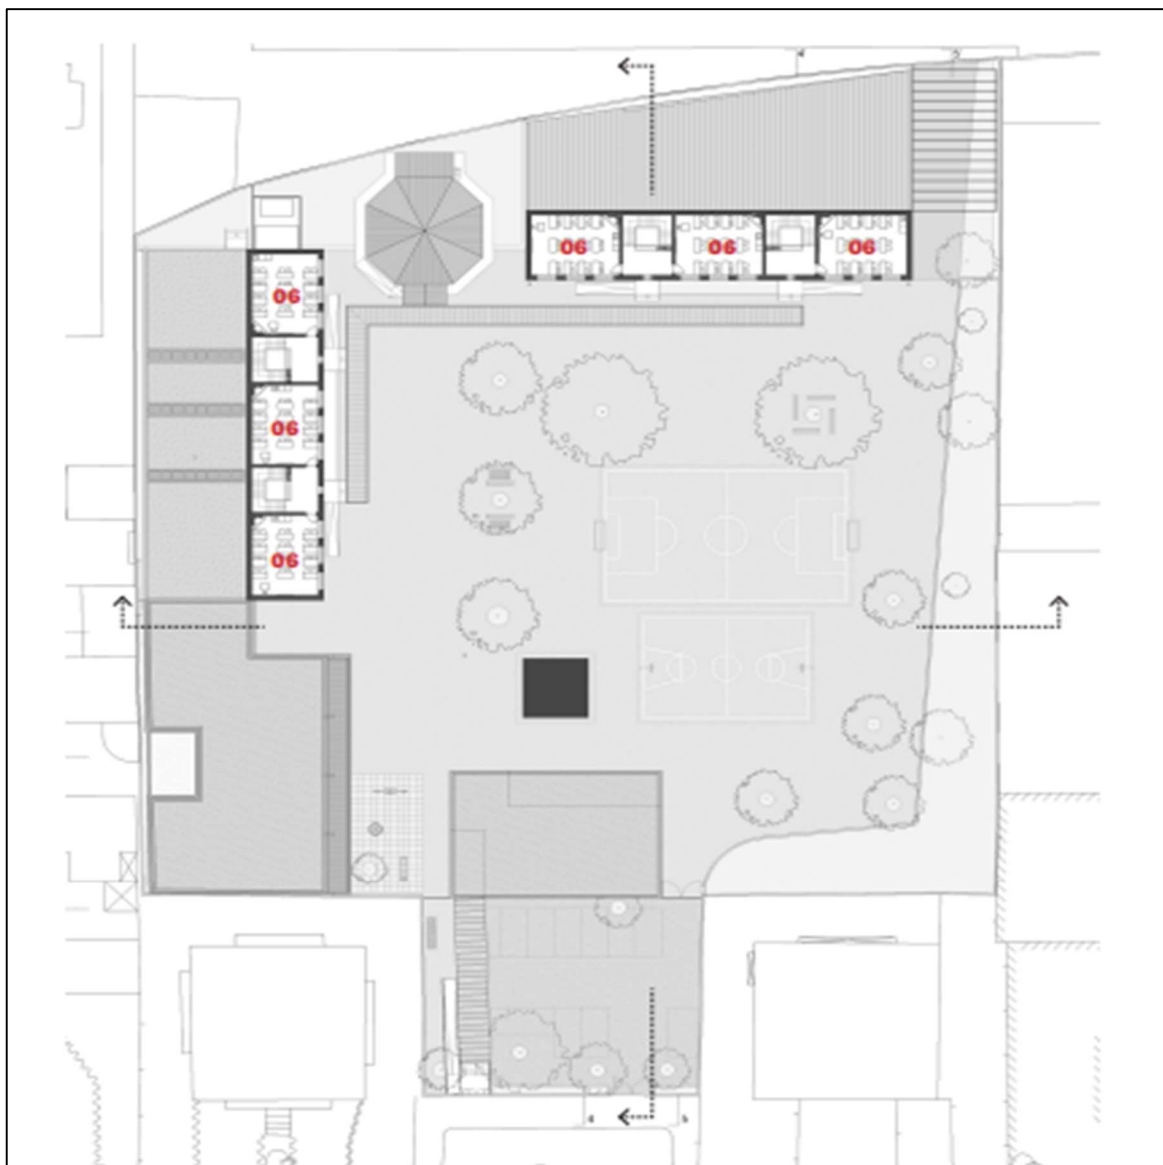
Planta baixa primeiro pav., escola Bom Sucesso, sem escala
